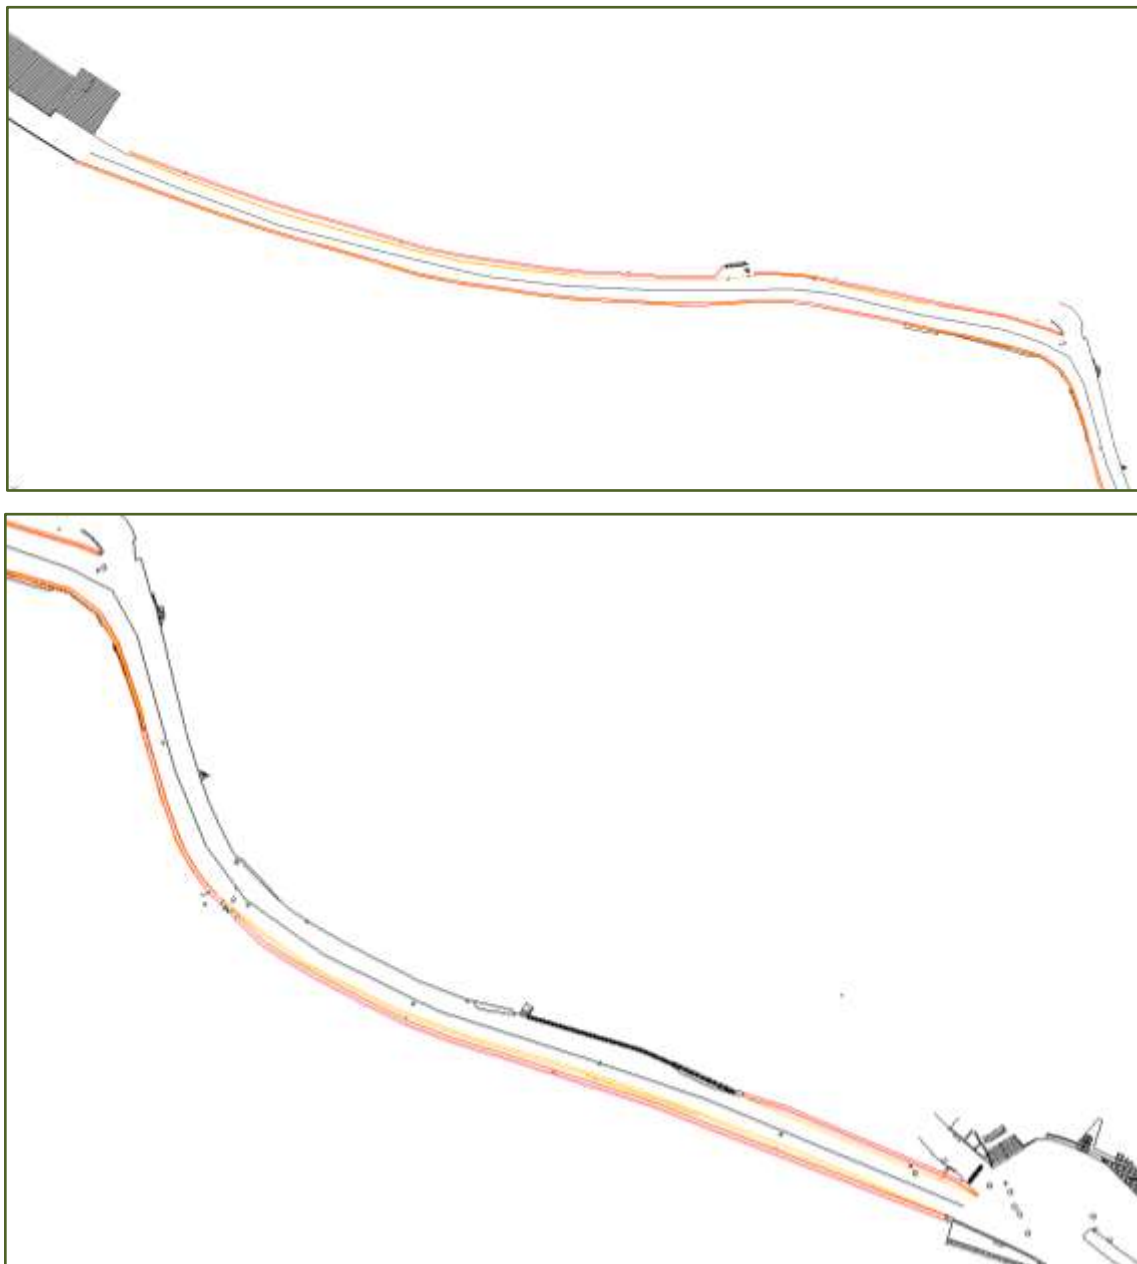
Planimetria di progetto (Arch. Marco Offredi)
